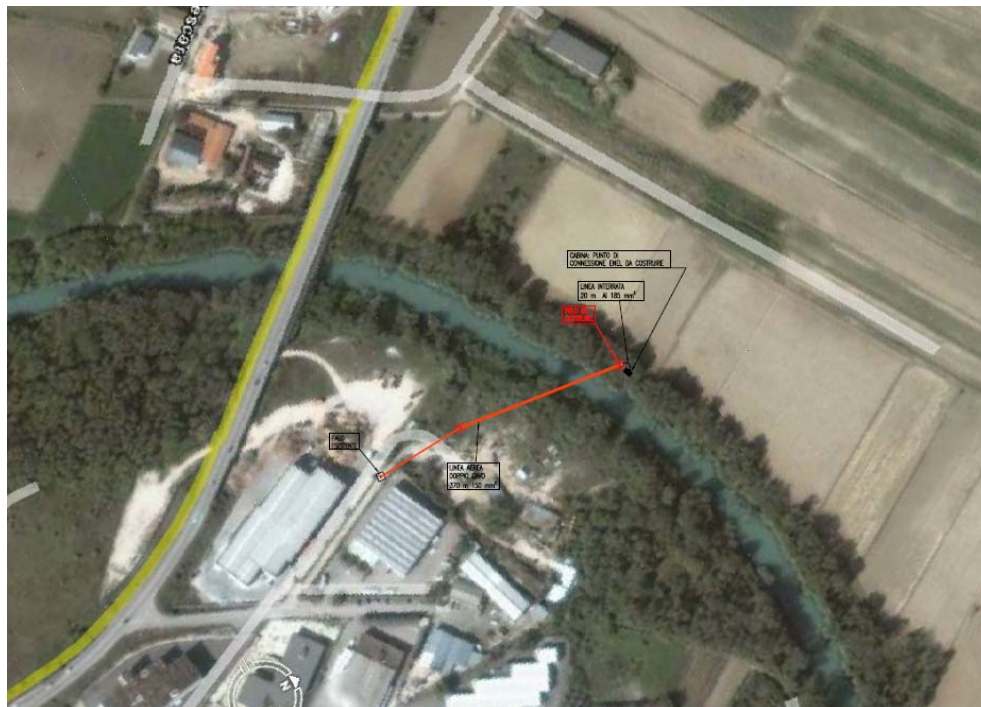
Individuazione della connessione a Enel per la centrale di Santa Teresa
